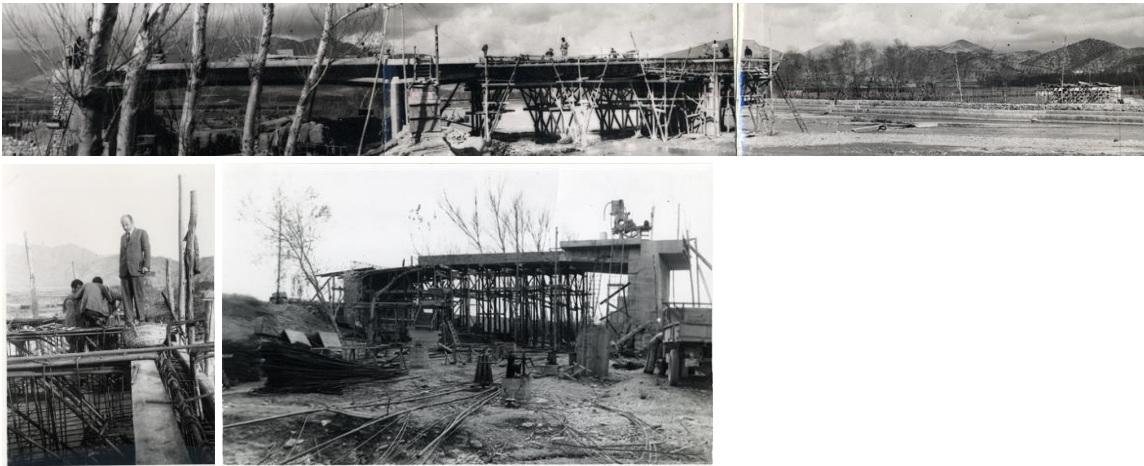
Imágenes de la construcción del puente sobre el río Guadalfeo.
